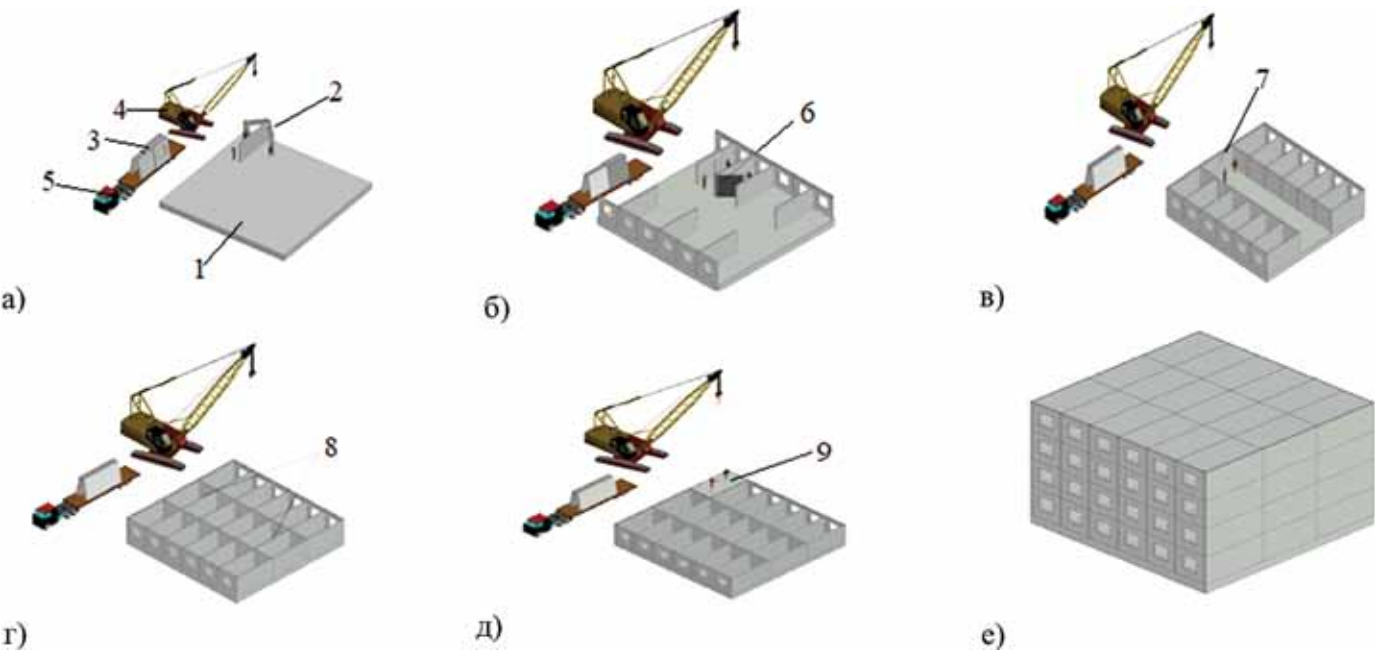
а) Установка стены в указанном месте: 1 – фундамент, 2 – стены (2, 4, 2), 3 – стены находятся в режиме заводской сборки, 4 – гусеничный кран; 5 – грузовая платформа; б) Установка стены в указанном месте над фундаментом: 6 – стены (3, 4, 3), 7 – стены (5); г) Установка стены в указанном месте над фундаментом: 8 – стены (6); д) Установка плит перекрытия в указанном месте над фундаментом: 9 – плиты перекрытия; е) Завершенное здание
